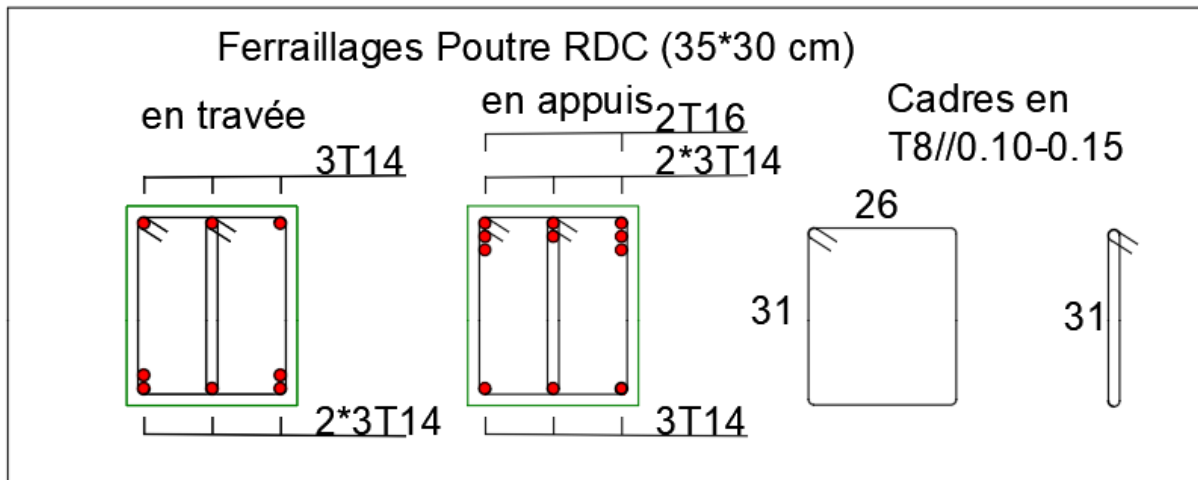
Ferraillages Poutre RDC 35\*30 cm.
